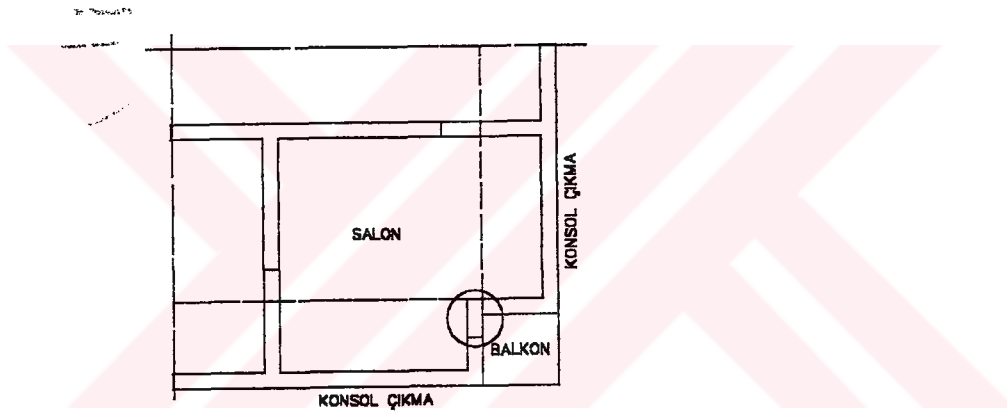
Kiriş akslarının şaşırtmalı olması sonucu kolonların büyük yapılması (Bayülke, 1998).
